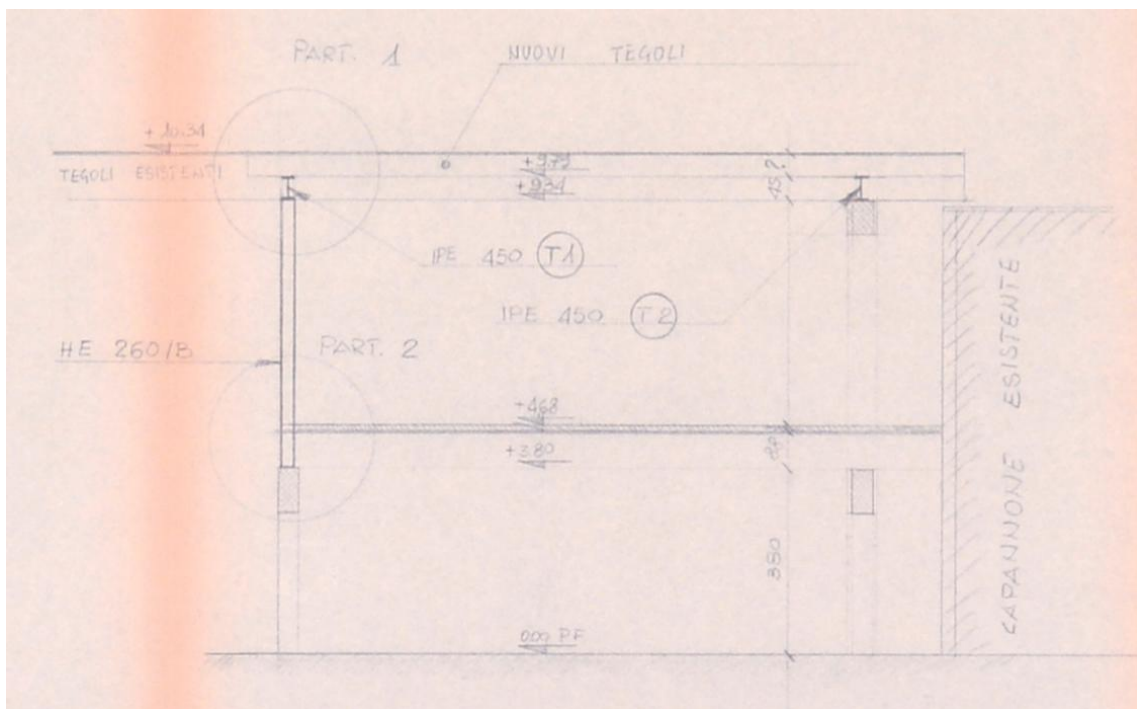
Particolare di A.1990.a.sa.T01 - Struttura in acciaio - Sezione tipo
